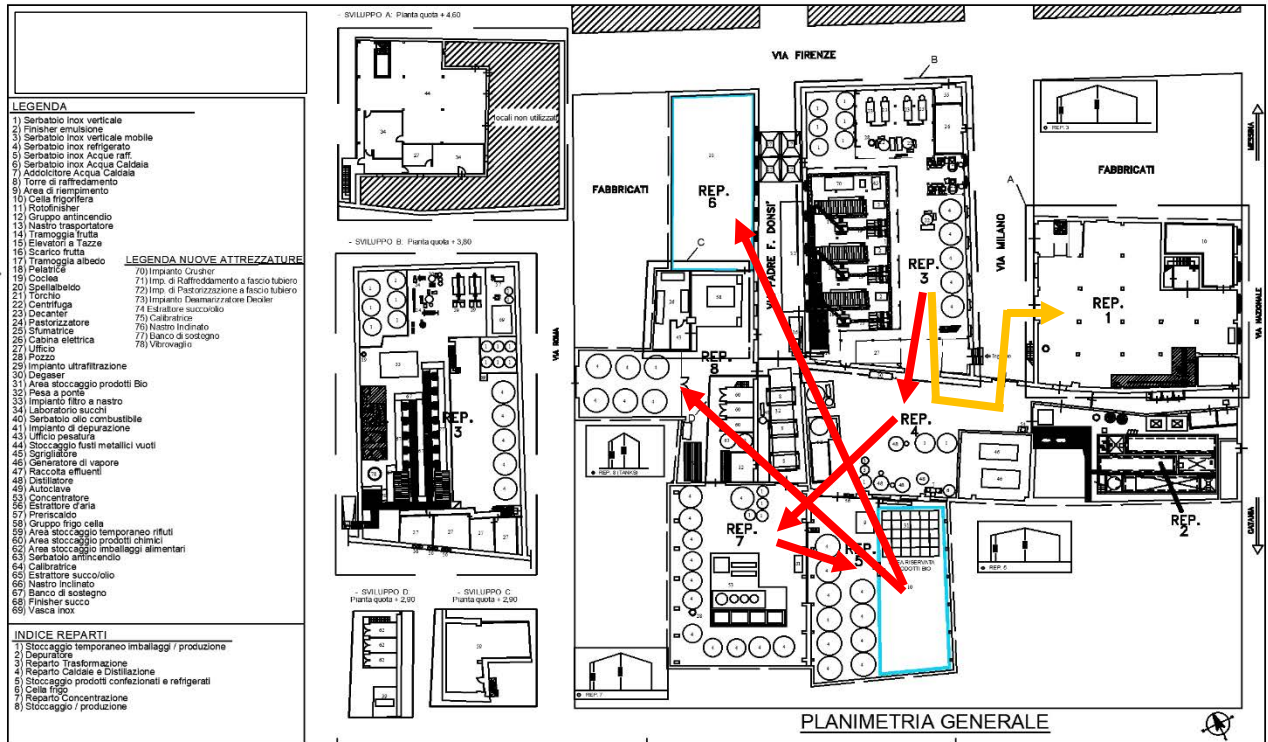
Planimetria generale stabilimento succhi concentrati
